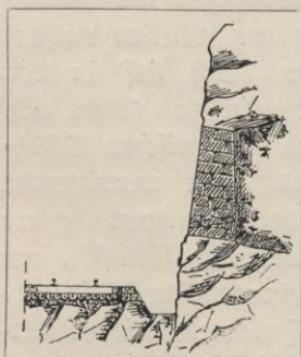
Ausmauerung der Köpfe loser Felschichten.
